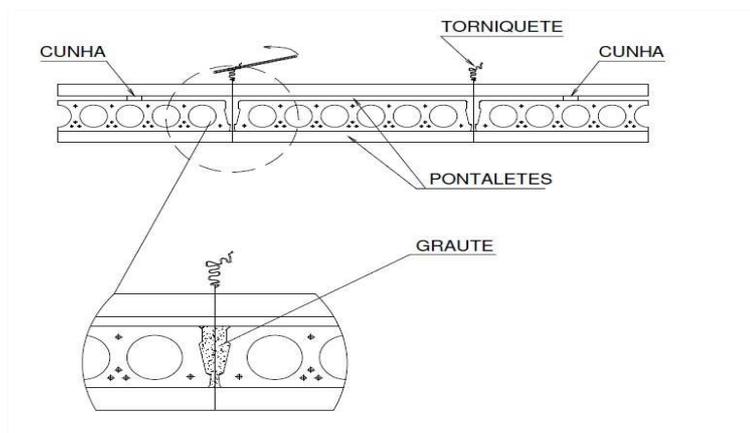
Esquema de equalização da capa de lajes alveolares detalhadas em projeto (PETRUCCELLI, 2009)
